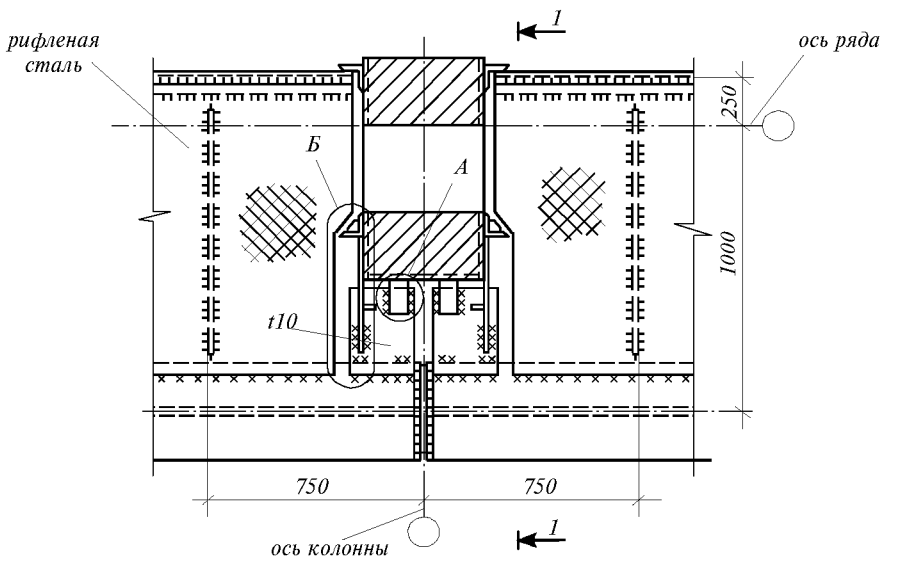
Сопряжение разрезных подкрановых конструкций в уровне верхнего пояса при тормозной балке и железобетонной колонне
